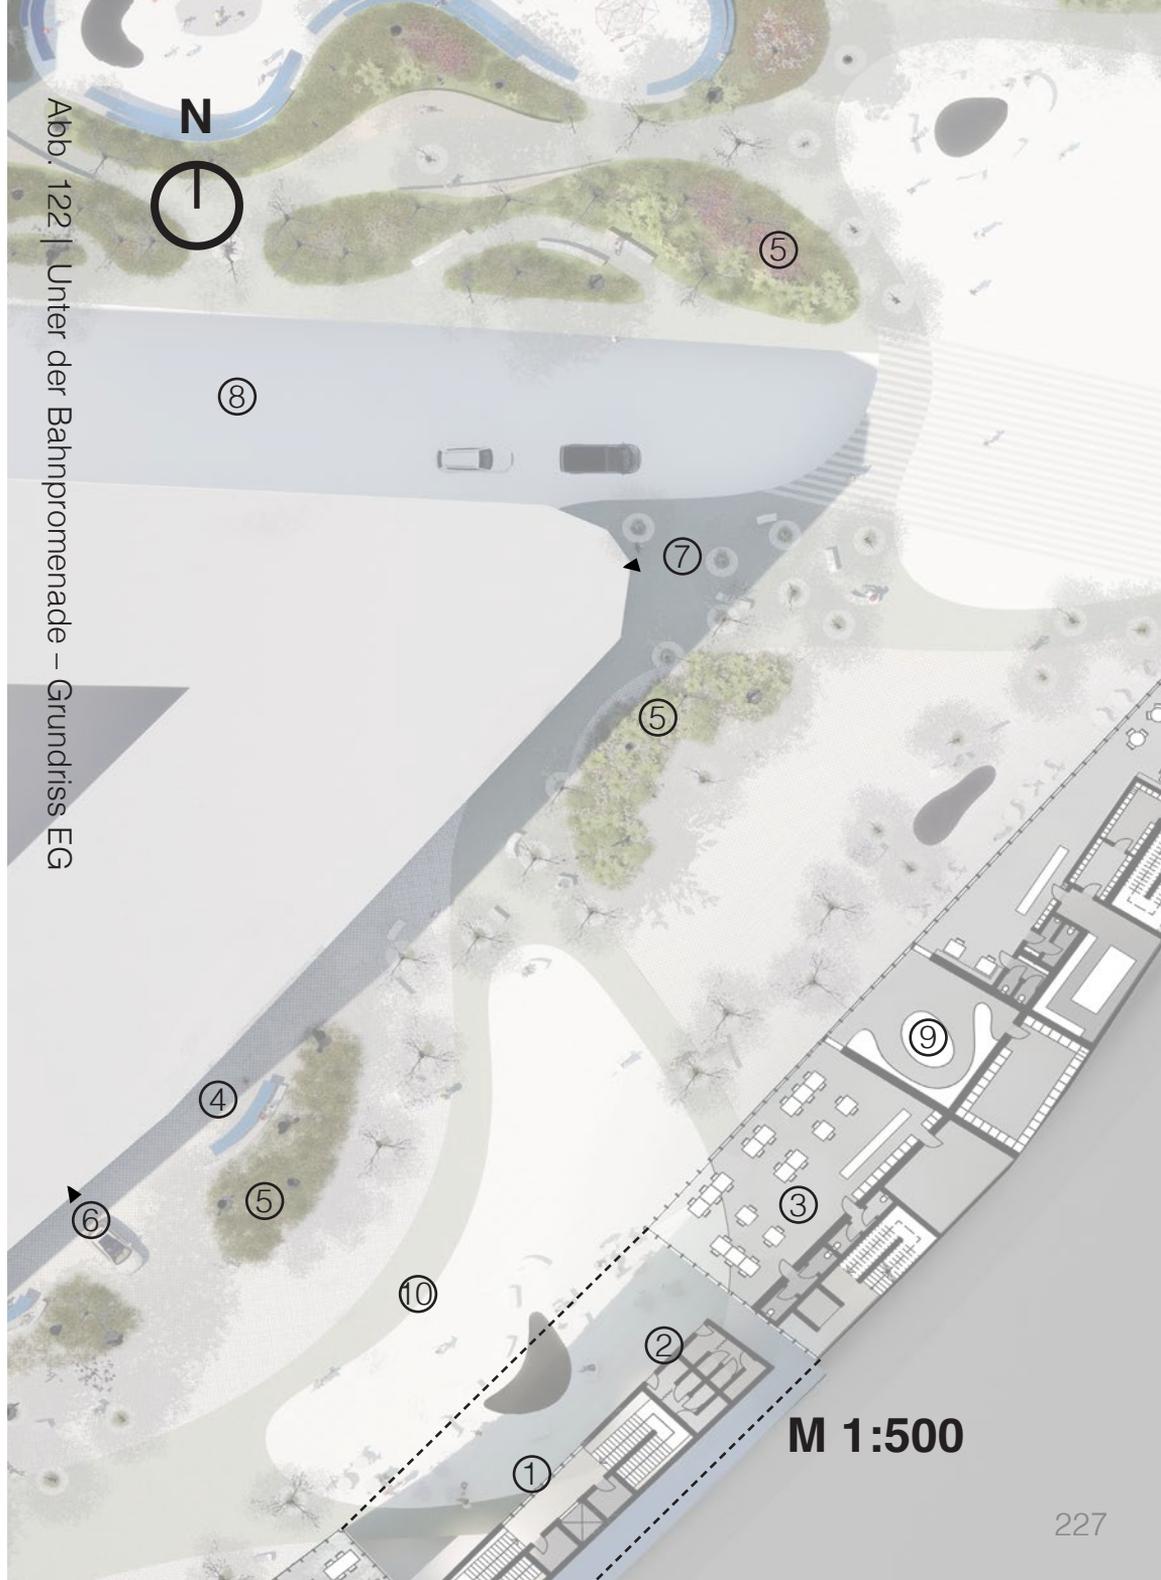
| Unter der Bahnpromenade – Grundriss EG
